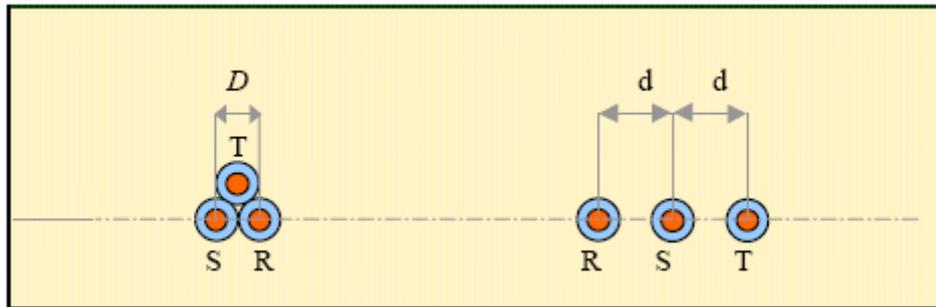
Modalità di disposizione delle fasi a trifoglio o in piano
